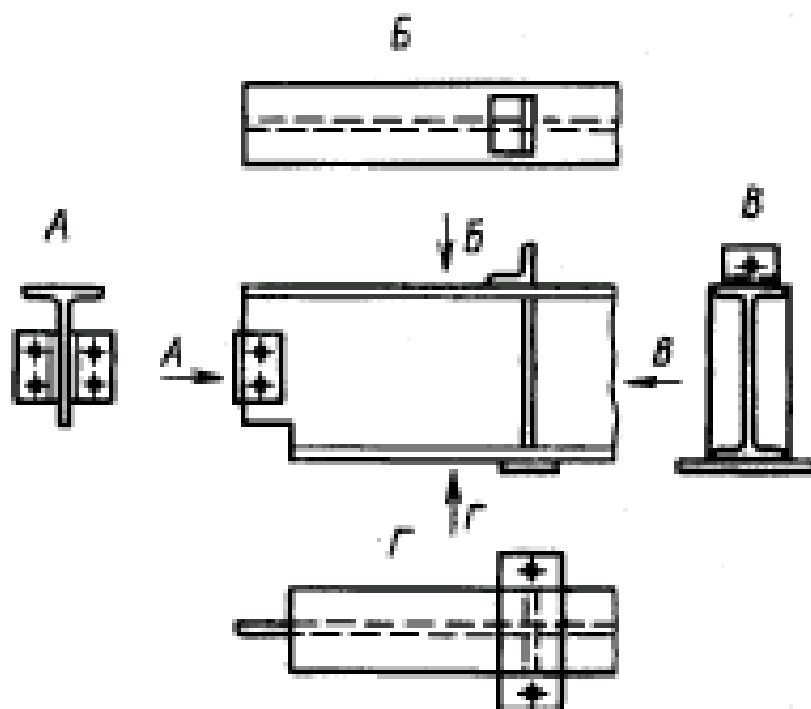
Обозначение видов на чертежах металлоконструкций
